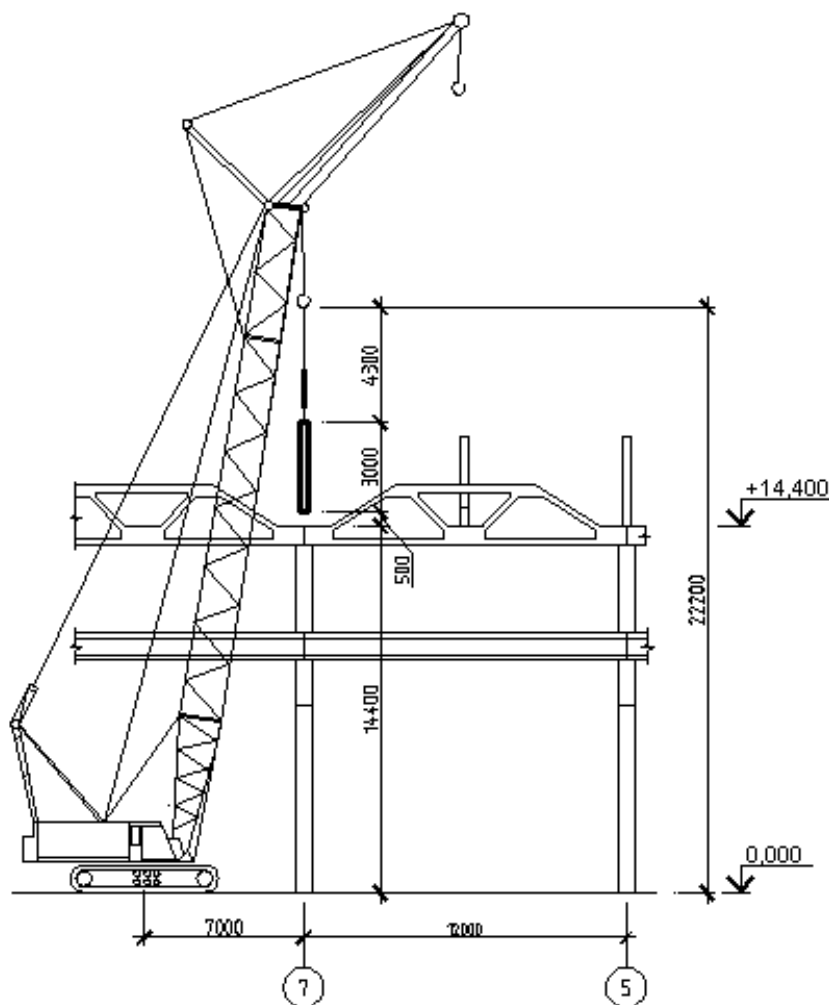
Разрез схемы монтажа стропильной фермы с опиранием на подстропильные фермы
